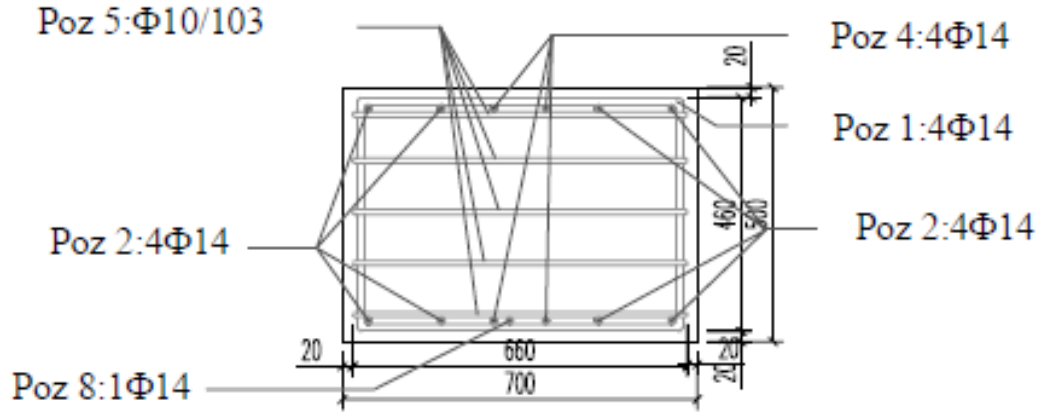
Kolon Donatı Düzeni ve Detayı
